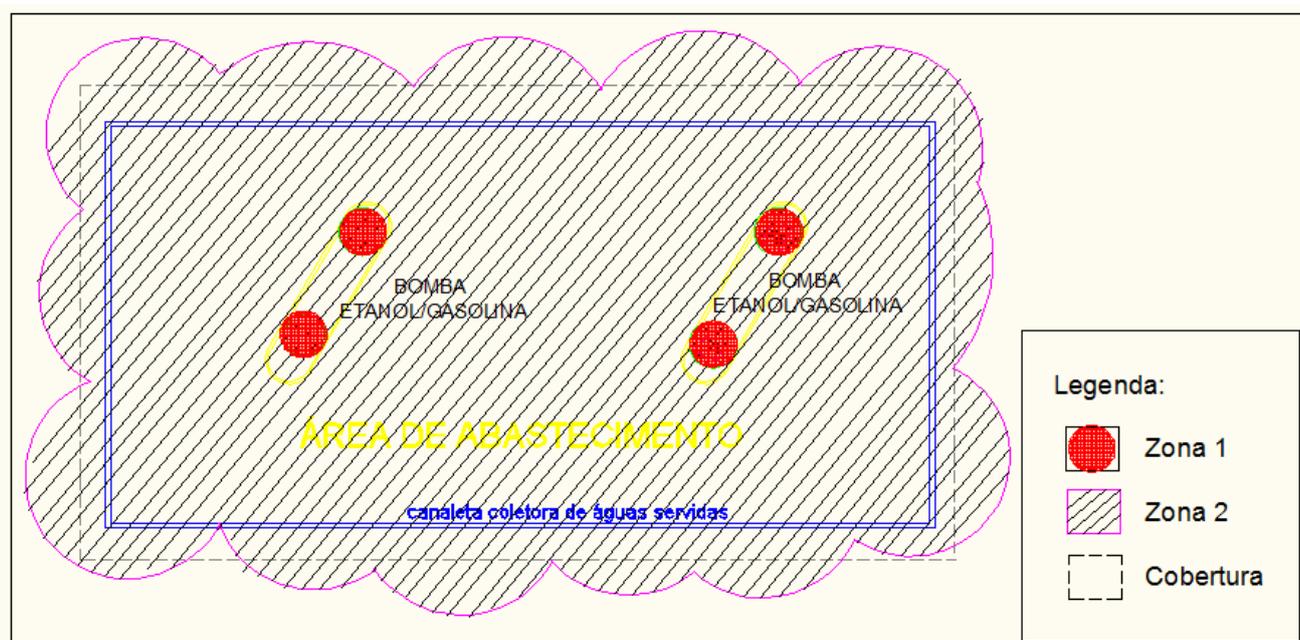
Croqui das zonas de riscos da área de abastecimento
